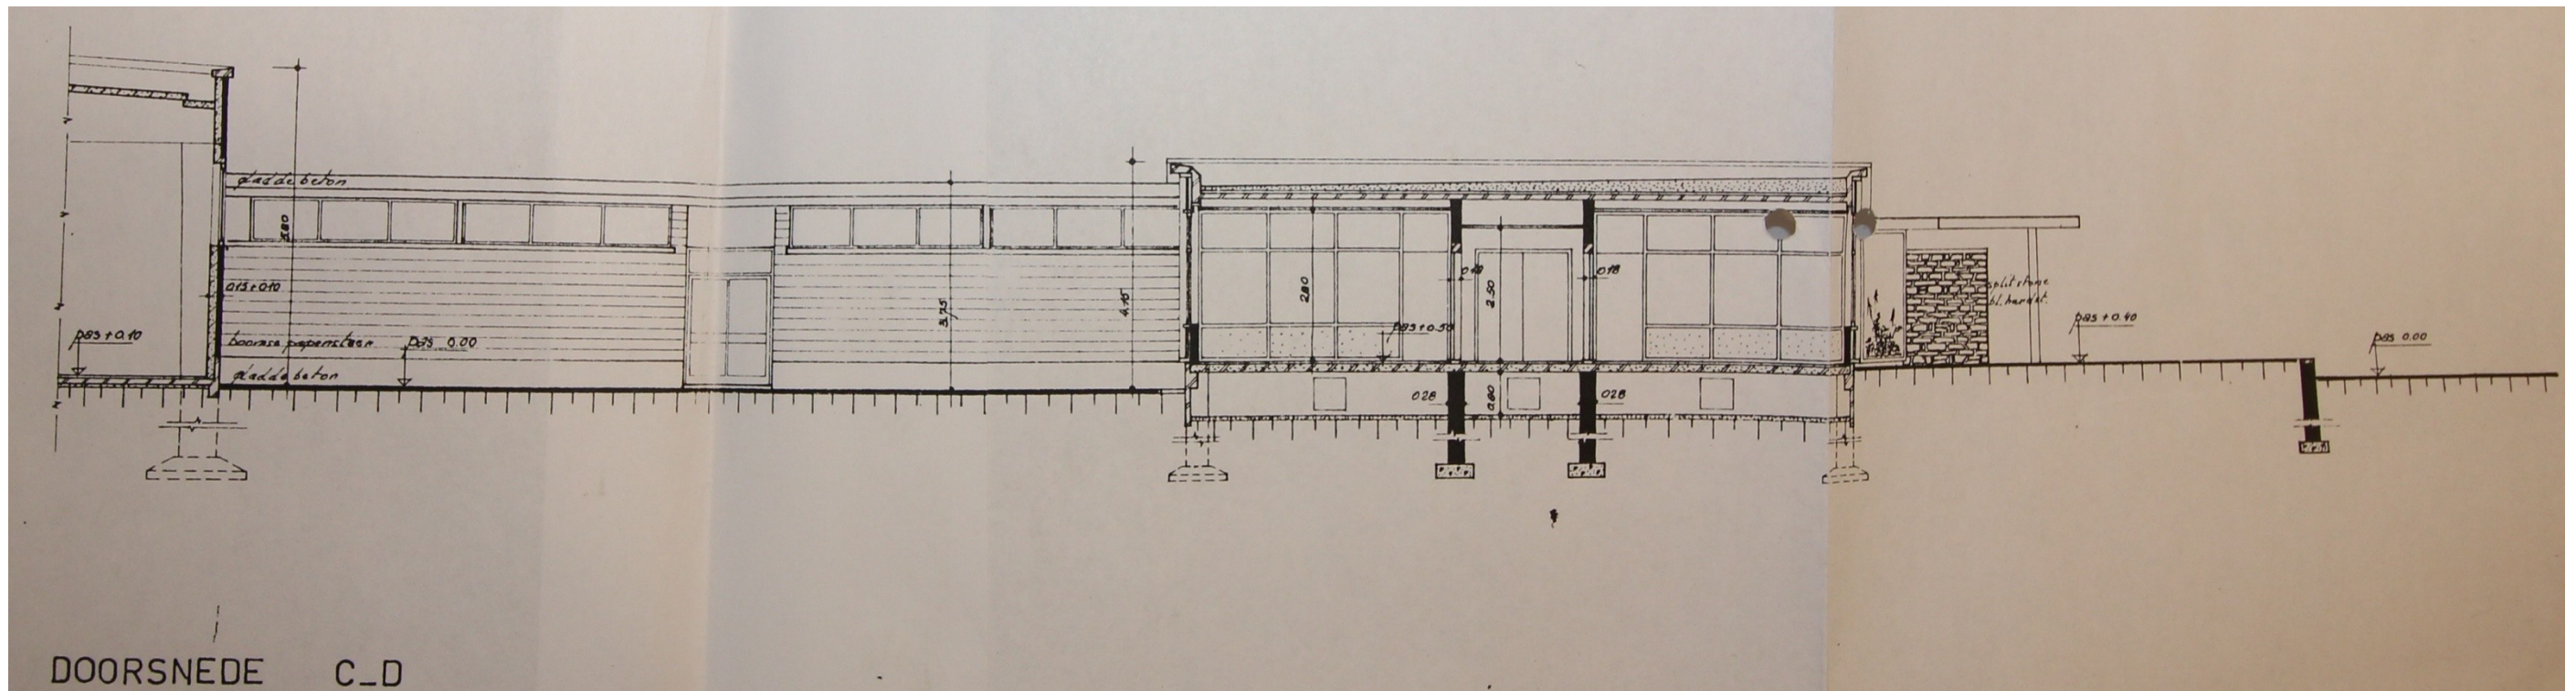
Doorsnede C-D van de plannen uit 1964 (architect Paul M. Tombeur).
